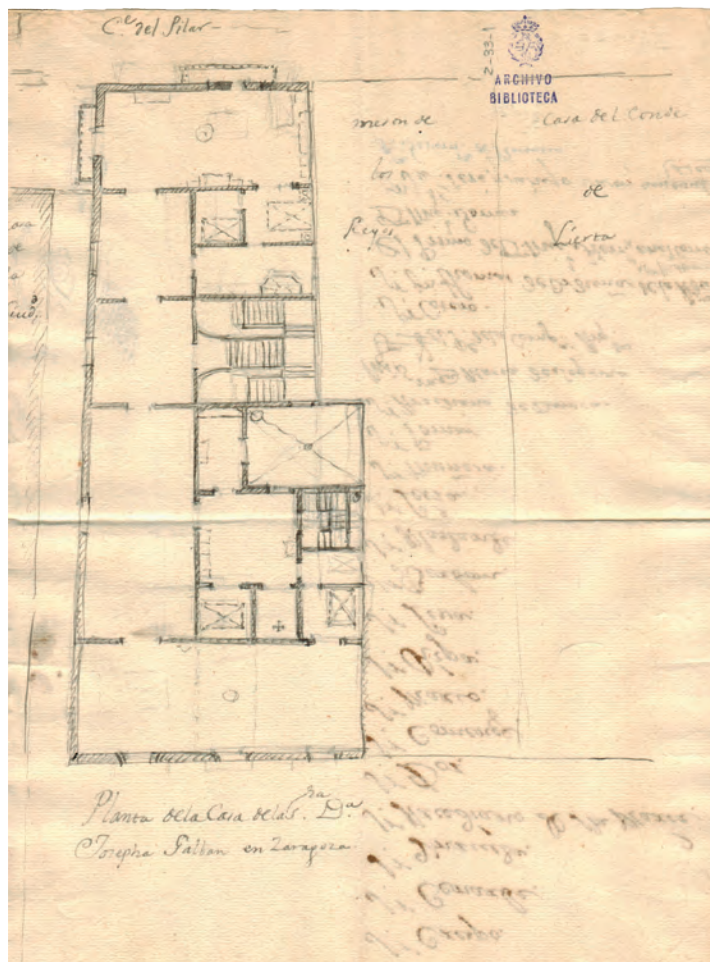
Planta de la vivienda de Josefa Galván en Zaragoza. R.A.B.A.S.F., ARCHIVO-BIBLIOTECA, 2-33-1
